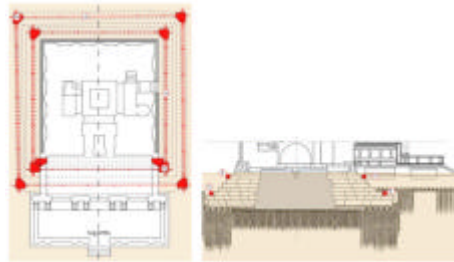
• Venezia, Campanile di San Marco, disposizione delle barre dinamometriche in titanio nel masso di fondazione localizzate nella planimetria e nella sezione: 1) barre dinamometriche; 2) elementi angolari per l'ancoraggio delle barre.
